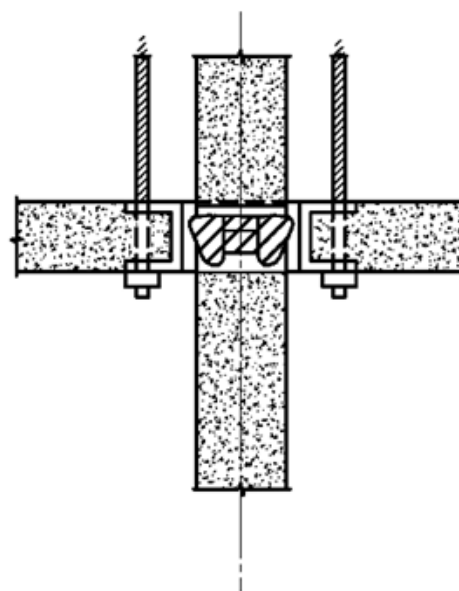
Устройство бортовой опалубки для бетонирования пакета плит перекрытия:
